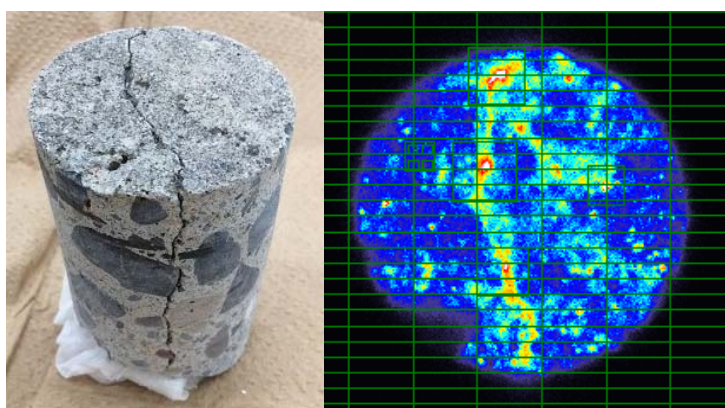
ひび割れを含むコンクリートコアと β 線ラジオグラフ
